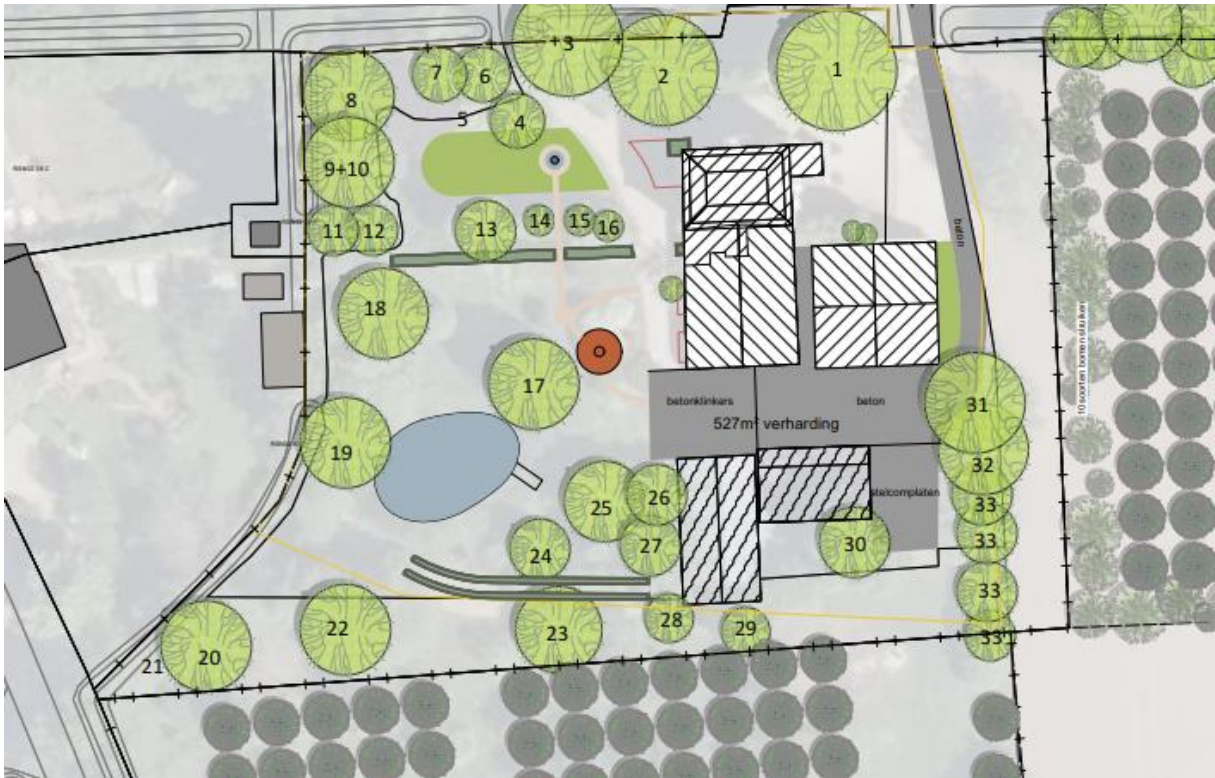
Situatietekening huidige situatie (bron: Boeijenjong Architecten)
